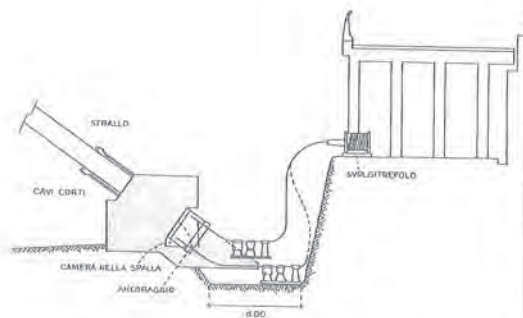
Infilaggio dei cavi lato spalla.
